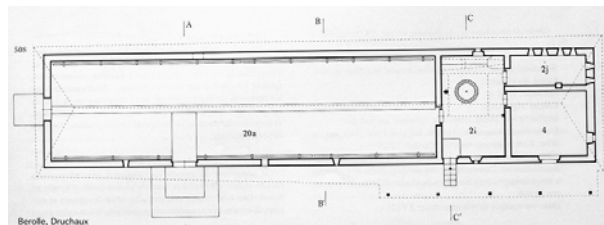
et 119 Chalet de plan allongé à Druchaux sur la commune de Bérulle.
